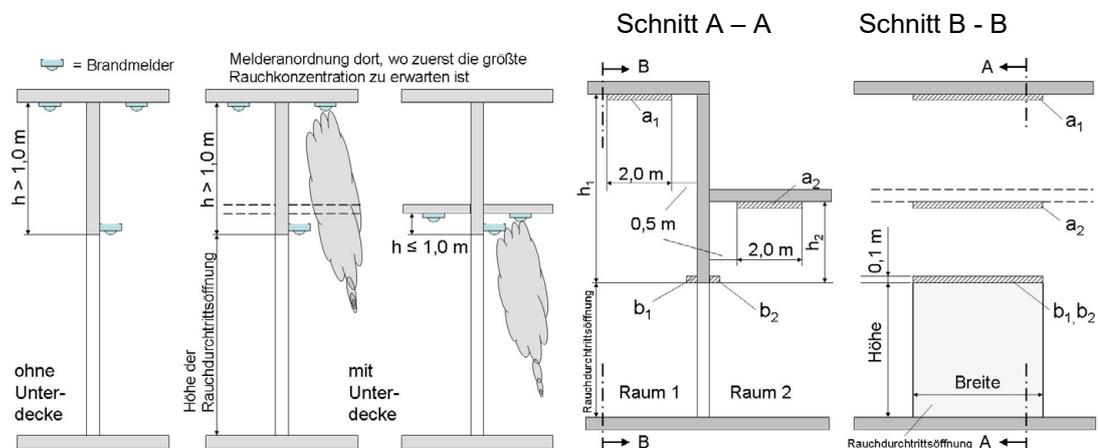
Maßgebende Höhe der Deckenunterfläche      Bild 2: Installationsbereiche
